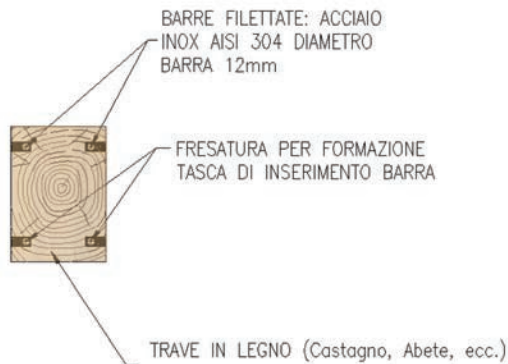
Ricostruzione dell'estremità di trave in legno appoggiata alla parete muraria mediante protesi di testata.
